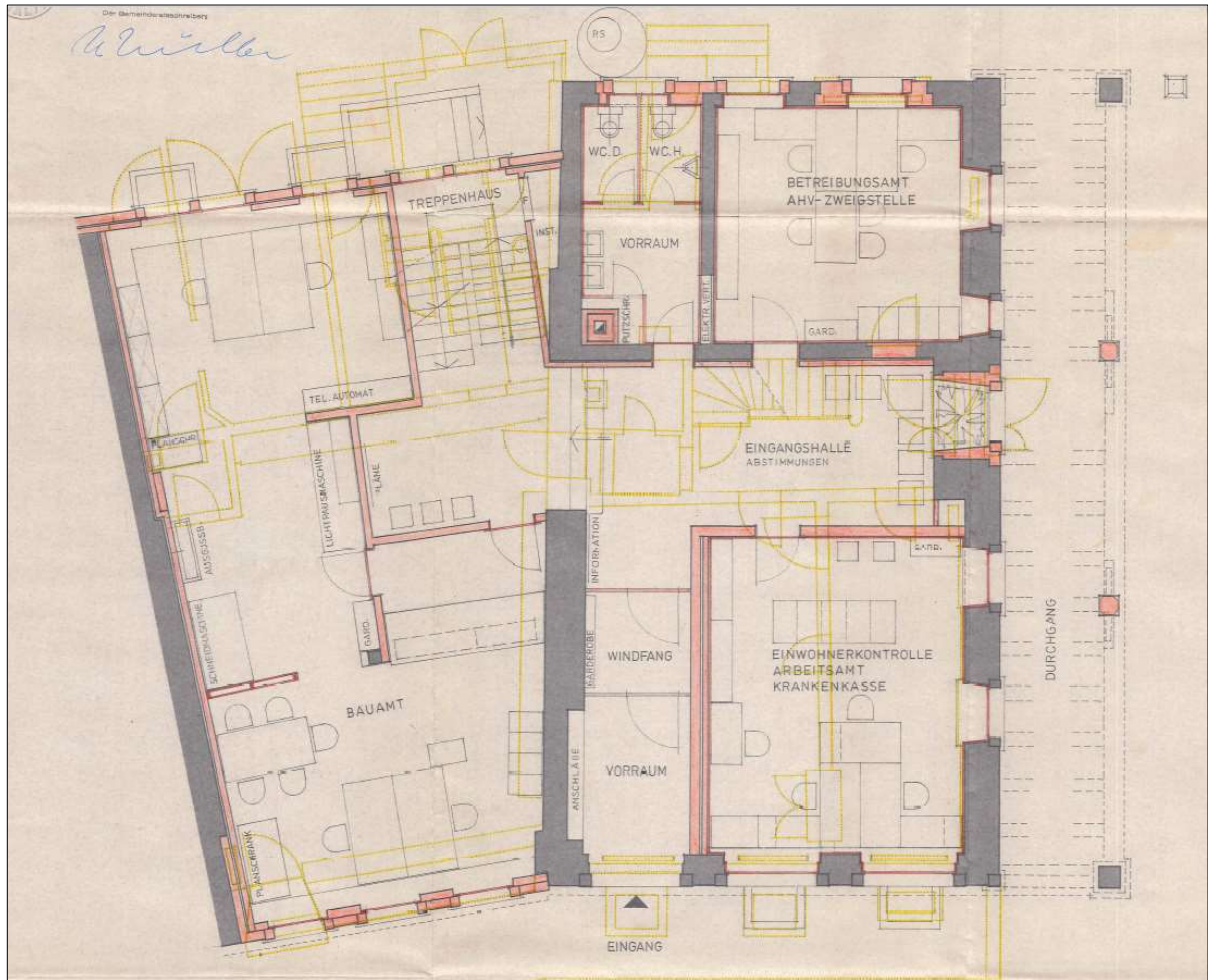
Grundriss Erdgeschoss. Projektplan von 1981.¹⁴ Diese Planung wurde mit kleinen Abweichungen umgesetzt. Der bis dahin auf der Ostfassade liegende Haupteingang wurde an die platzseitige Hauptfassade verlegt. Dazu wurde ein Fenster durch Entfernen des Brüstungsbereichs zum Zugang umgebaut. Die Öffnungen in der Ost- und Nordfassade wurden mehrheitlich überformt.
